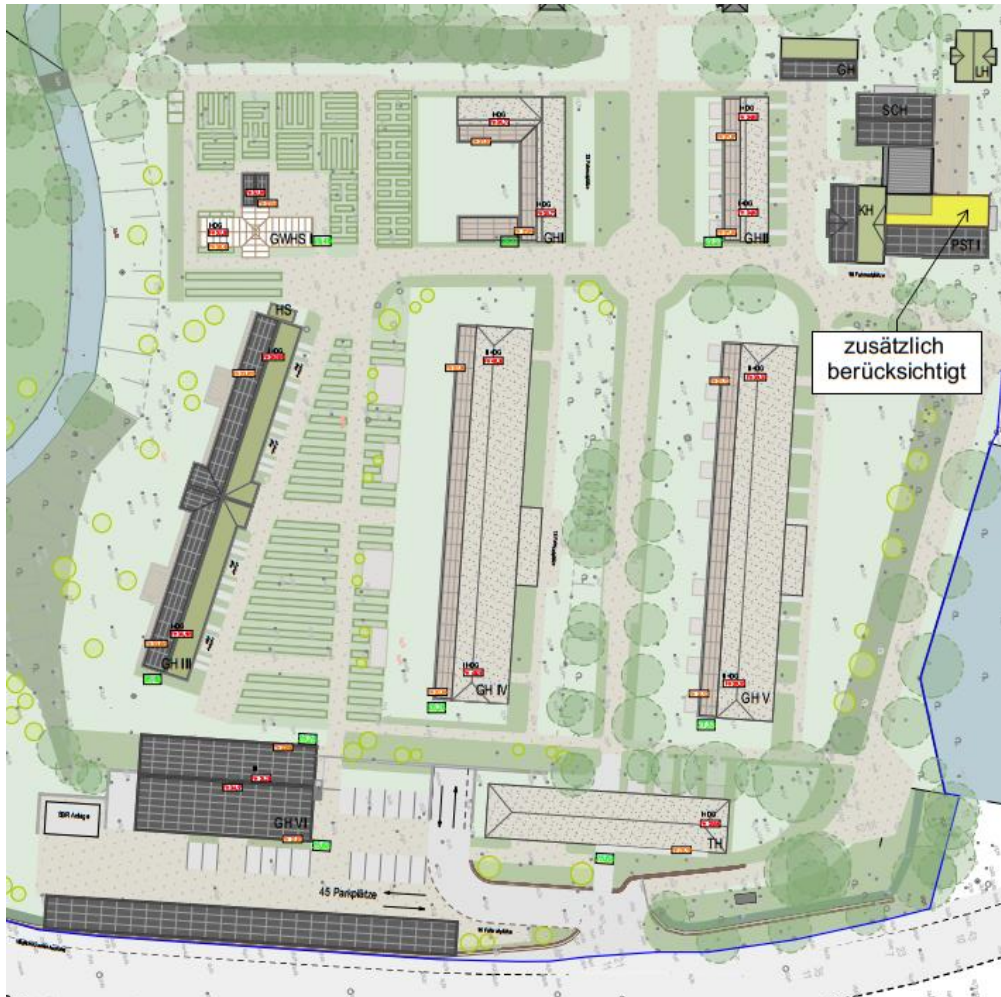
Lageplan der Liegenschaft mit gekennzeichneten PV-Flächen (Urbansky Architekten, angepasst durch AIB)
